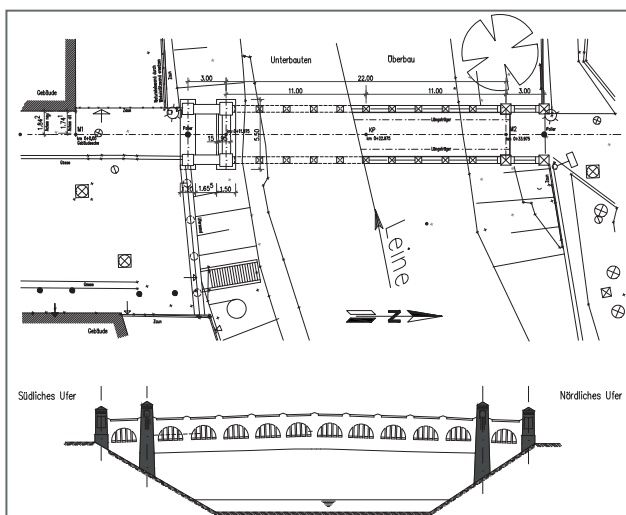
Entwurf der Brücke (Grundriss, Ansicht Ost)
